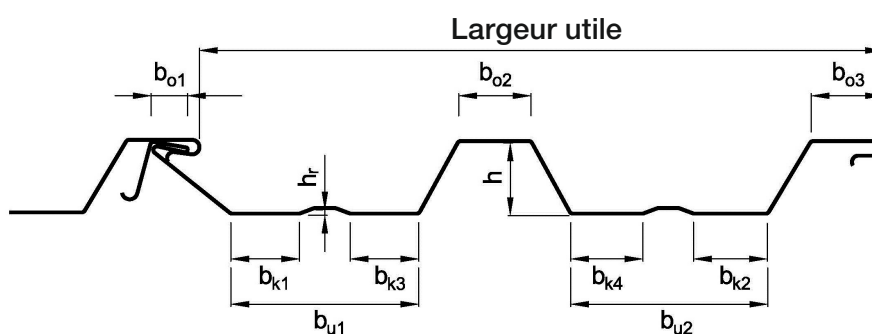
Section transversale des profilés à joint debout – type 4
